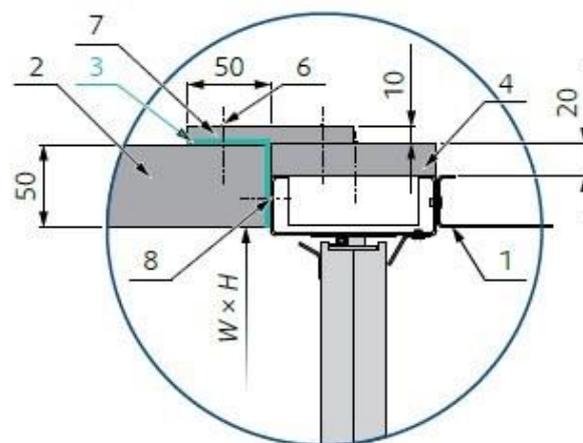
Sezione trasversale del collegamento con lastra della condotta di spessore 25 mm
